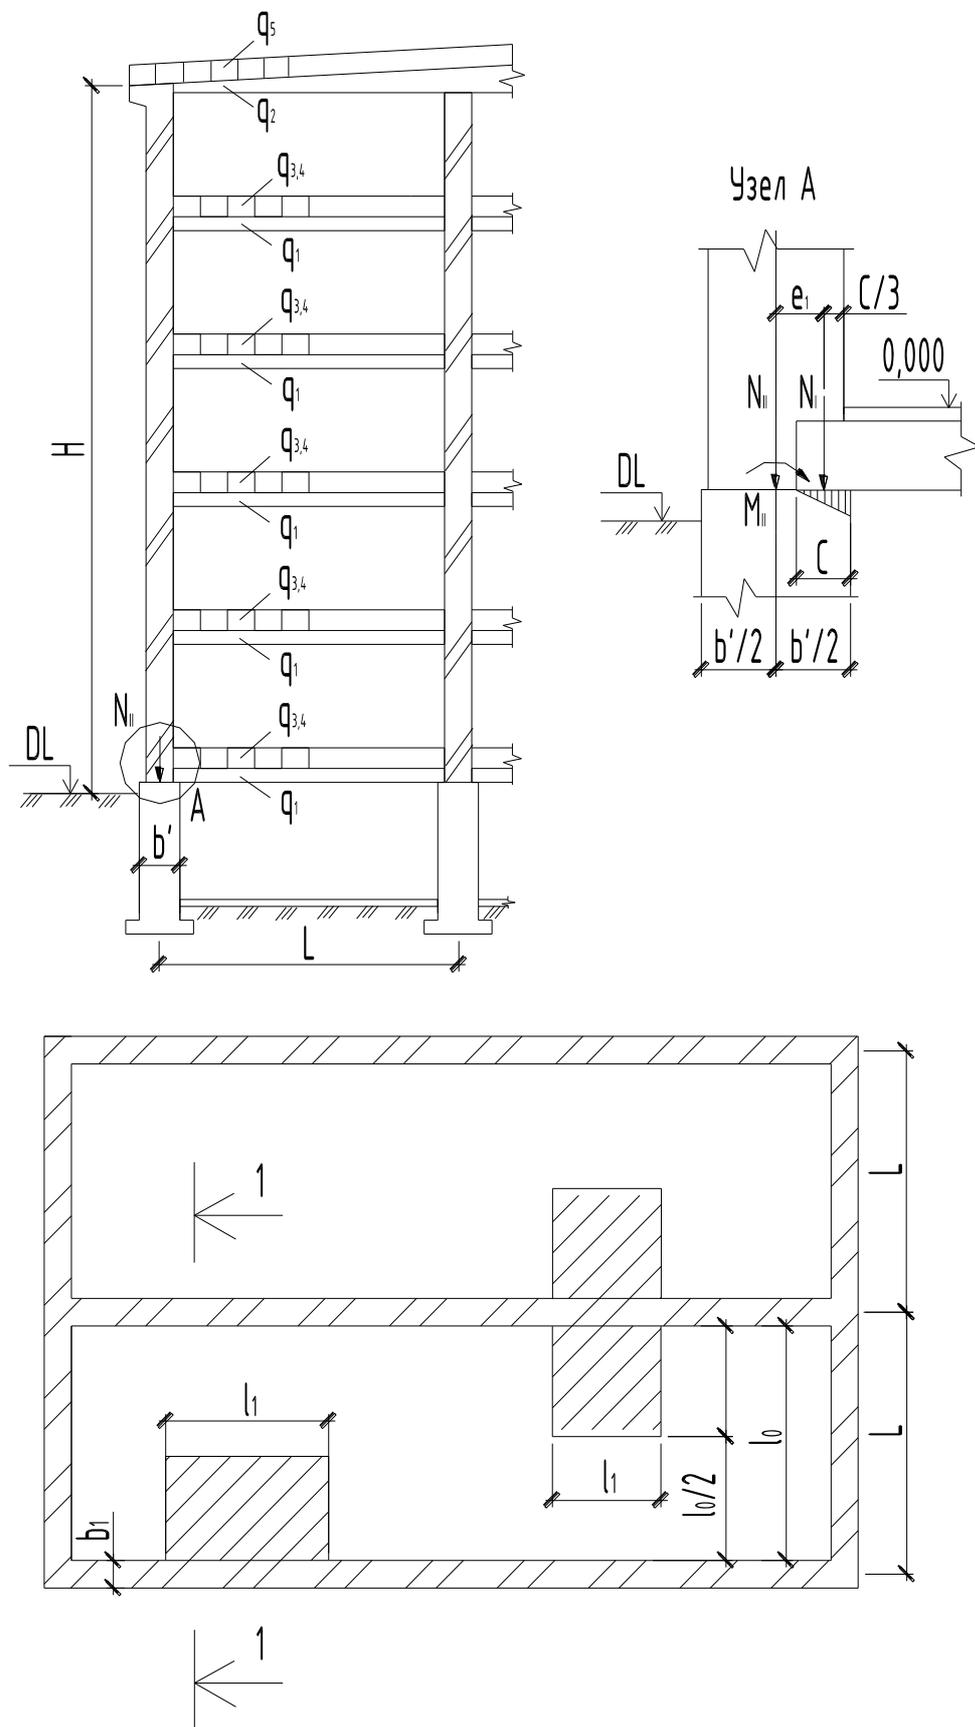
Схемы к расчету нагрузок на ленточный фундамент
